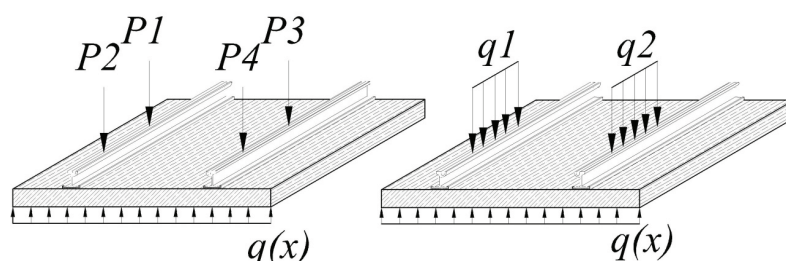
Схема передачи нагрузки на несущее бетонное основание при коэффициенте постели подошвенного вкладыша:
